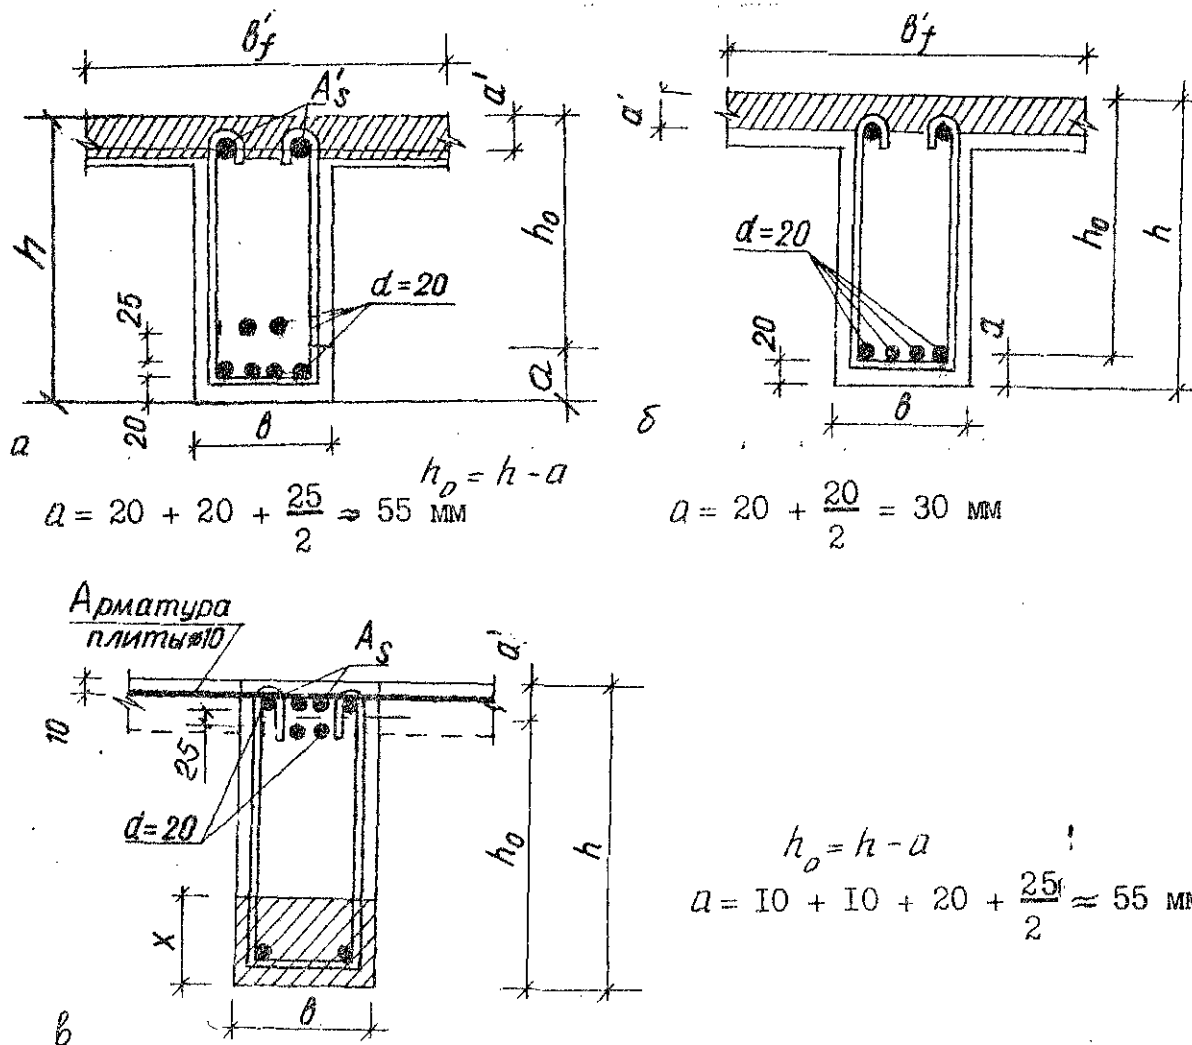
К расчету рабочей высоты сечения при армировании второстепенной балки вязаными каркасами: а — в пролете при размещении арматуры в два ряда; б — то же в один ряд; в — на опоре
